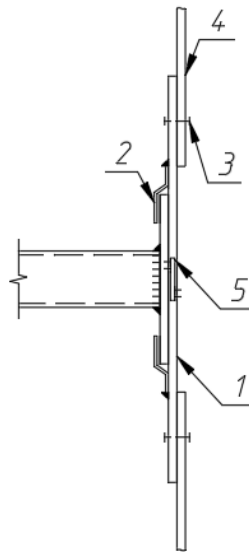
Конструкция для временного усиления кирпичных стен с проемами при демонтированных перекрытиях (изображен узел А на рис. 2):
